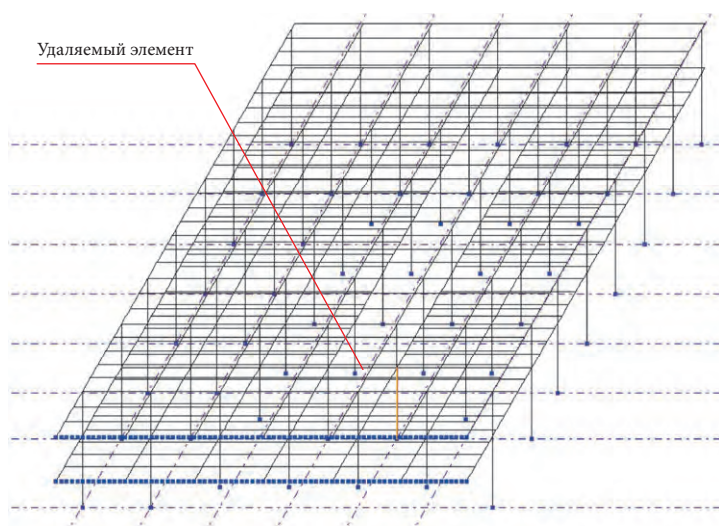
Вторичная расчетная схема с удаленным элементом. Плиты перекрытий условно не показаны
